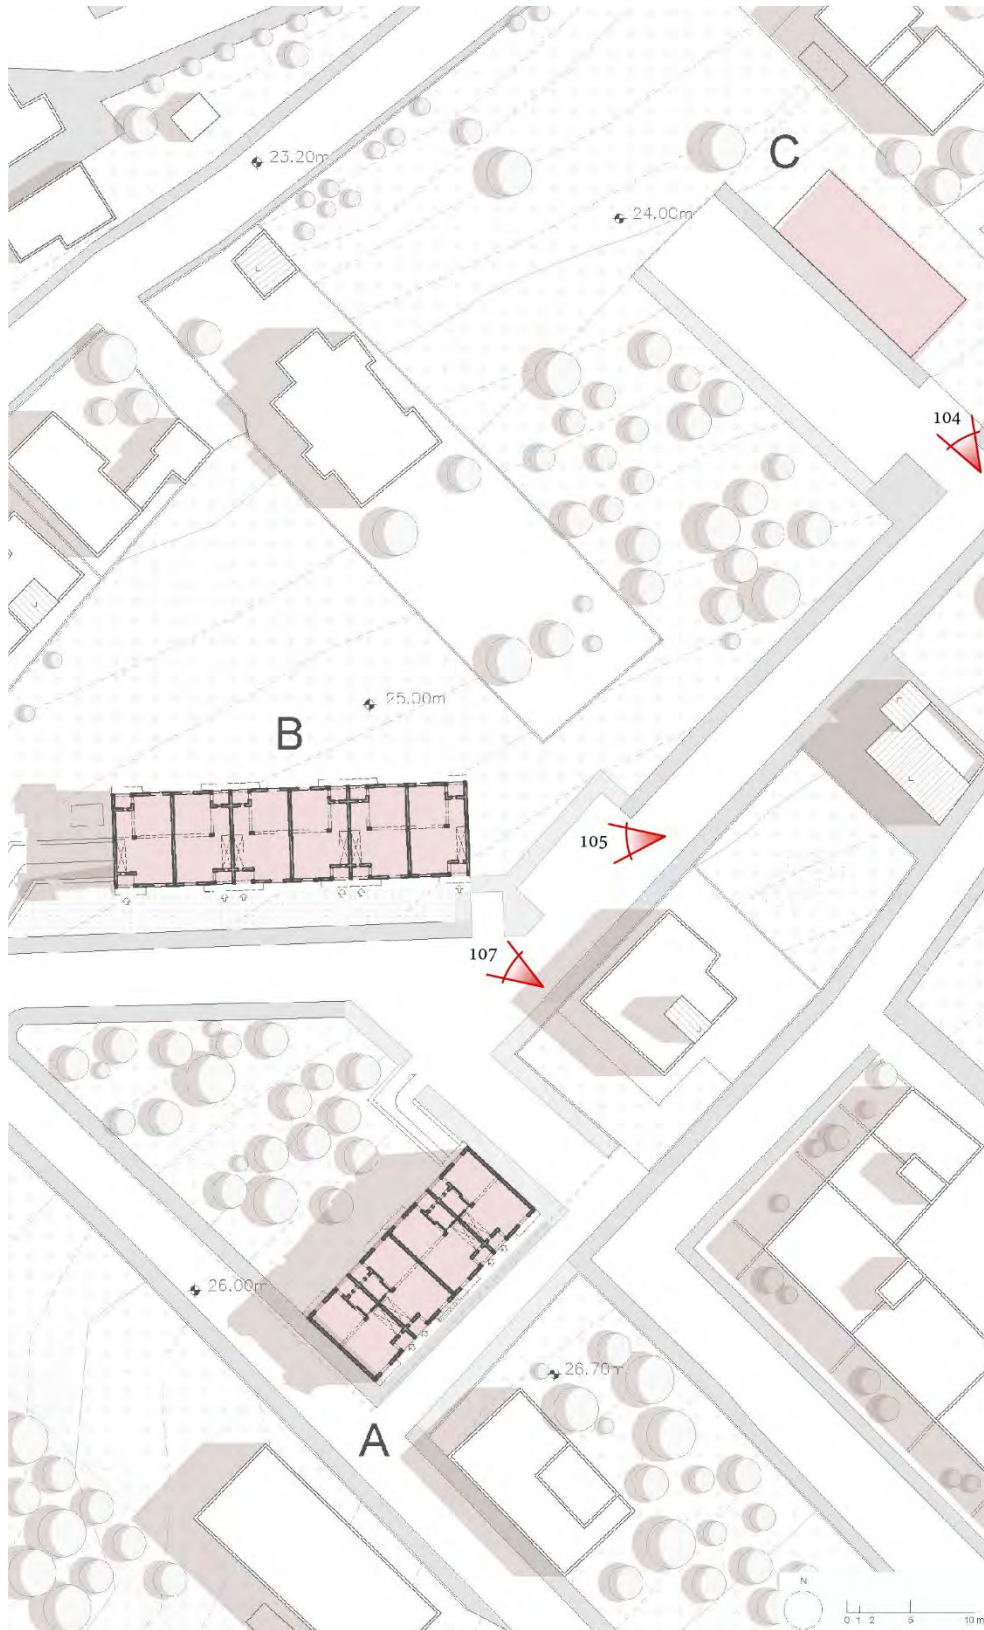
| Planimetria con coni ottici (credit: L. Cantoni; edit: F. Anania)
